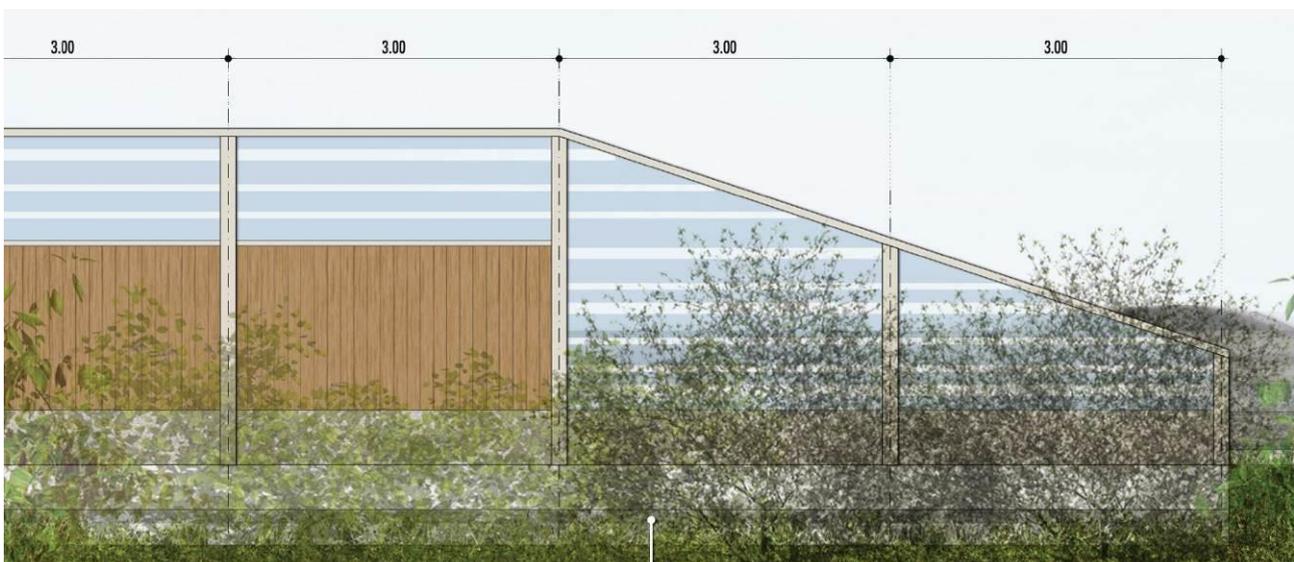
TIPOLOGICO DELLA TRANSIZIONE DI INIZIO/FINE BARRIERA - PROSPETTO SU RILEVATO, LATO RICETTORE
